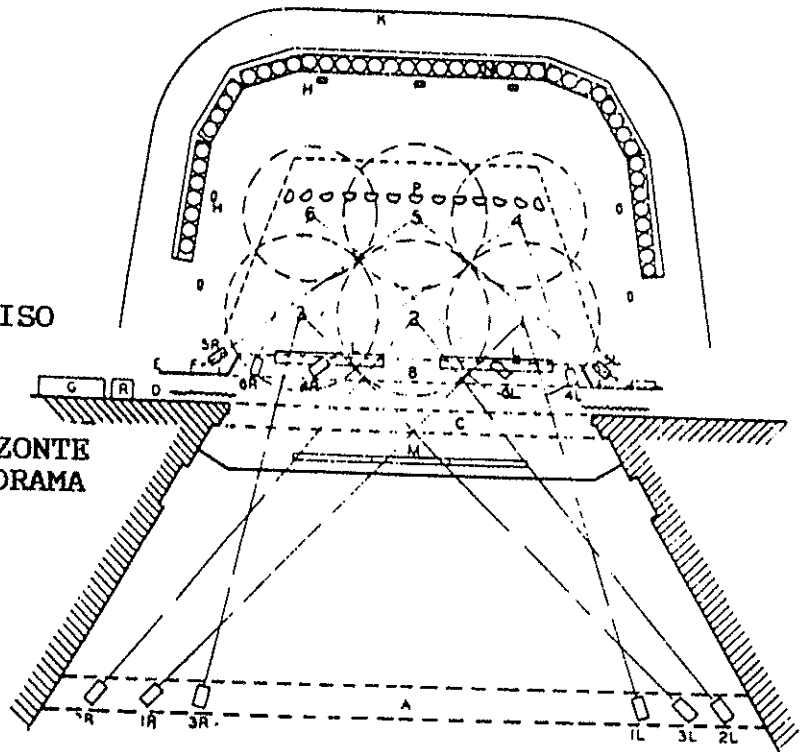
Vista de planta de la ubicación general del equipo sugerido en un plan estandar de iluminación.
